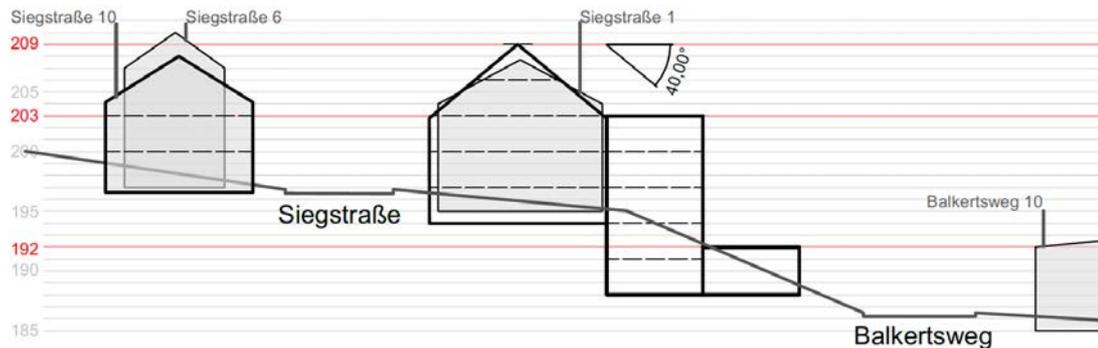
Beispielschnitt für eine mögliche Bebauung im Plangebiet (LOTH Städtebau + Stadtplanung 2023)
